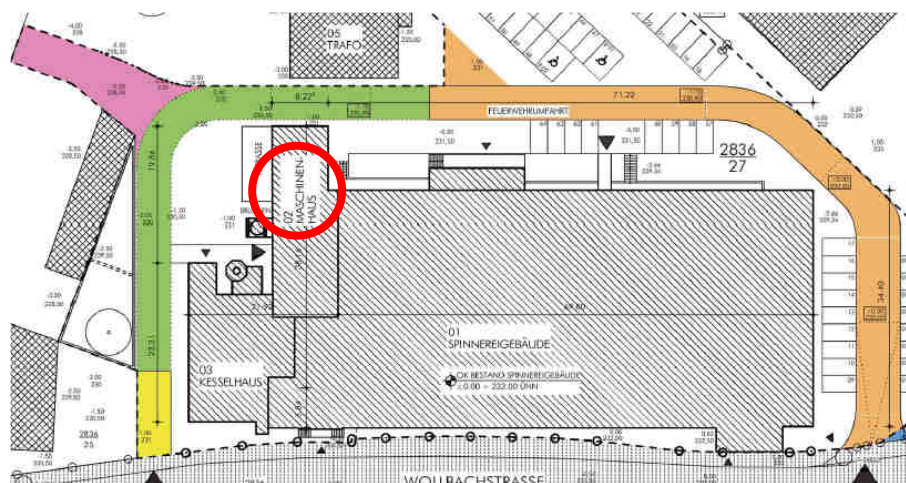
Übersicht Lageplan Wegerechte s.o. (Dienstbarkeiten)
